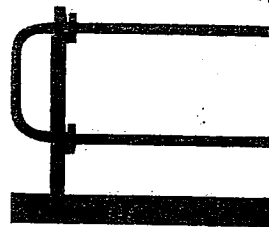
Dispositif de fixation par pincement de la dalle.
